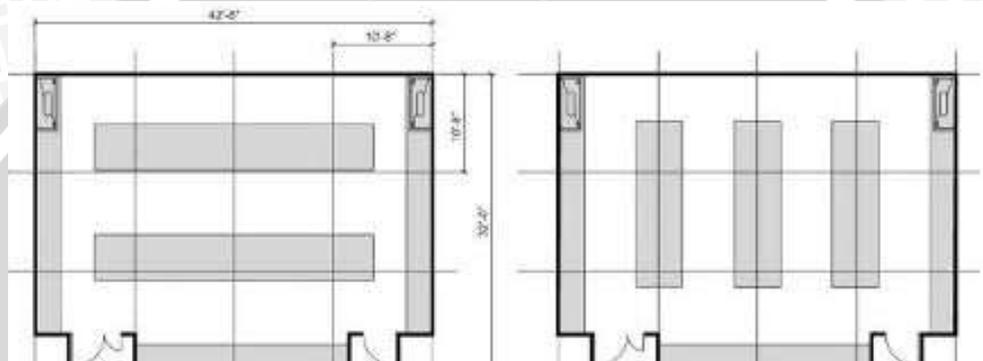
Denah dan potongan tipikal modul laboratorium
